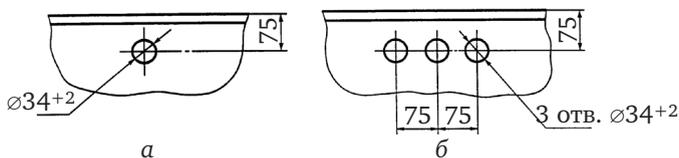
Расположение и размеры отверстий в полочках умывальников для установки смесителей:
